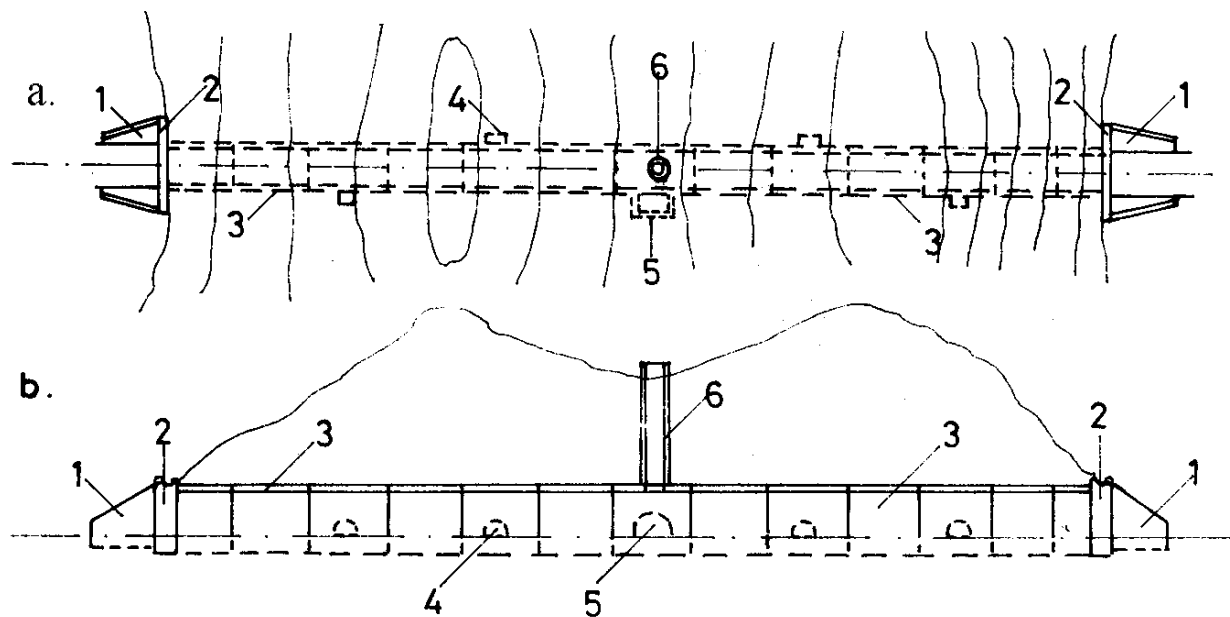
Elemente caracteristice tunel. Plan de situație (a), profil în lung (b).
